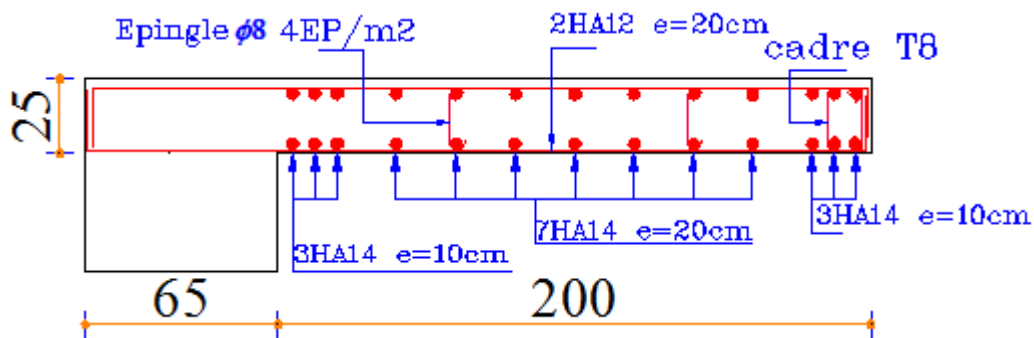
Schéma de ferrailage du voile VX4 de l'RDC
